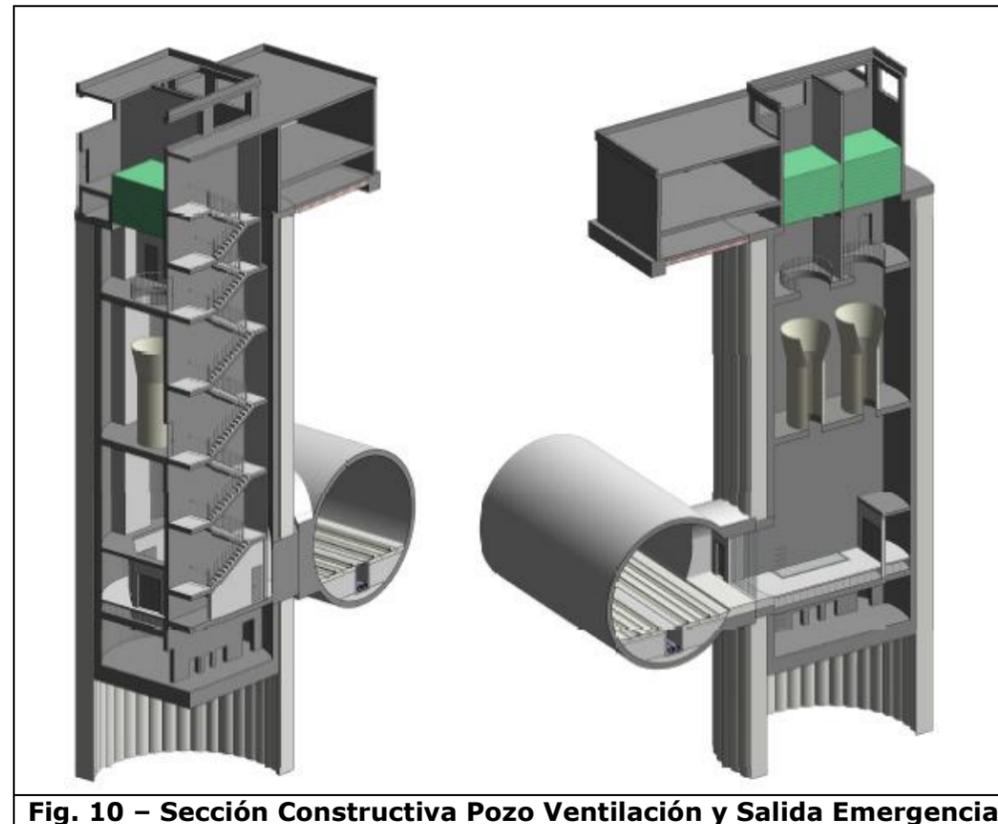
Sección Constructiva Pozo Ventilación y Salida Emergencia
